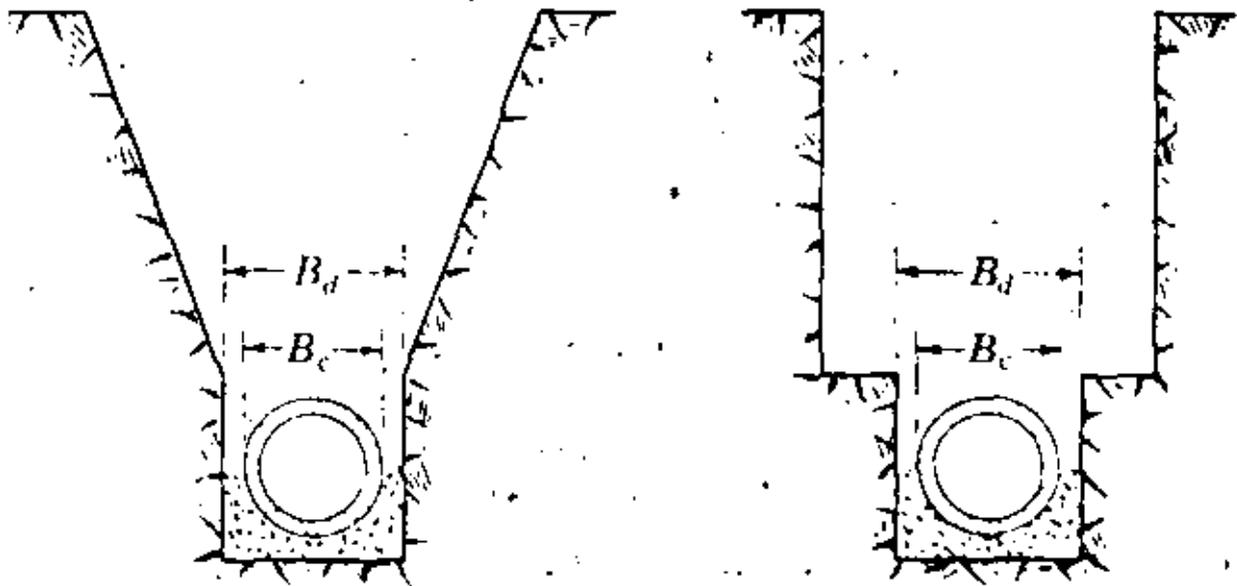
EJEMPLOS DE SUB-ZANJAS
